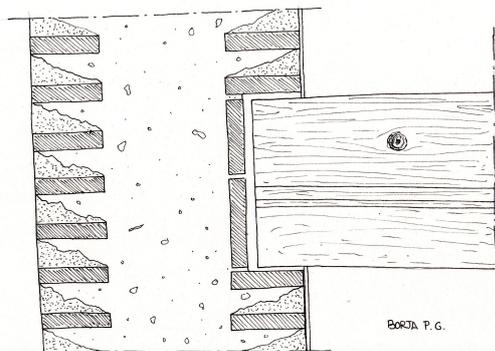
Detalle del encuentro de la viga de madera con el muro de tapia realizado por el autor
